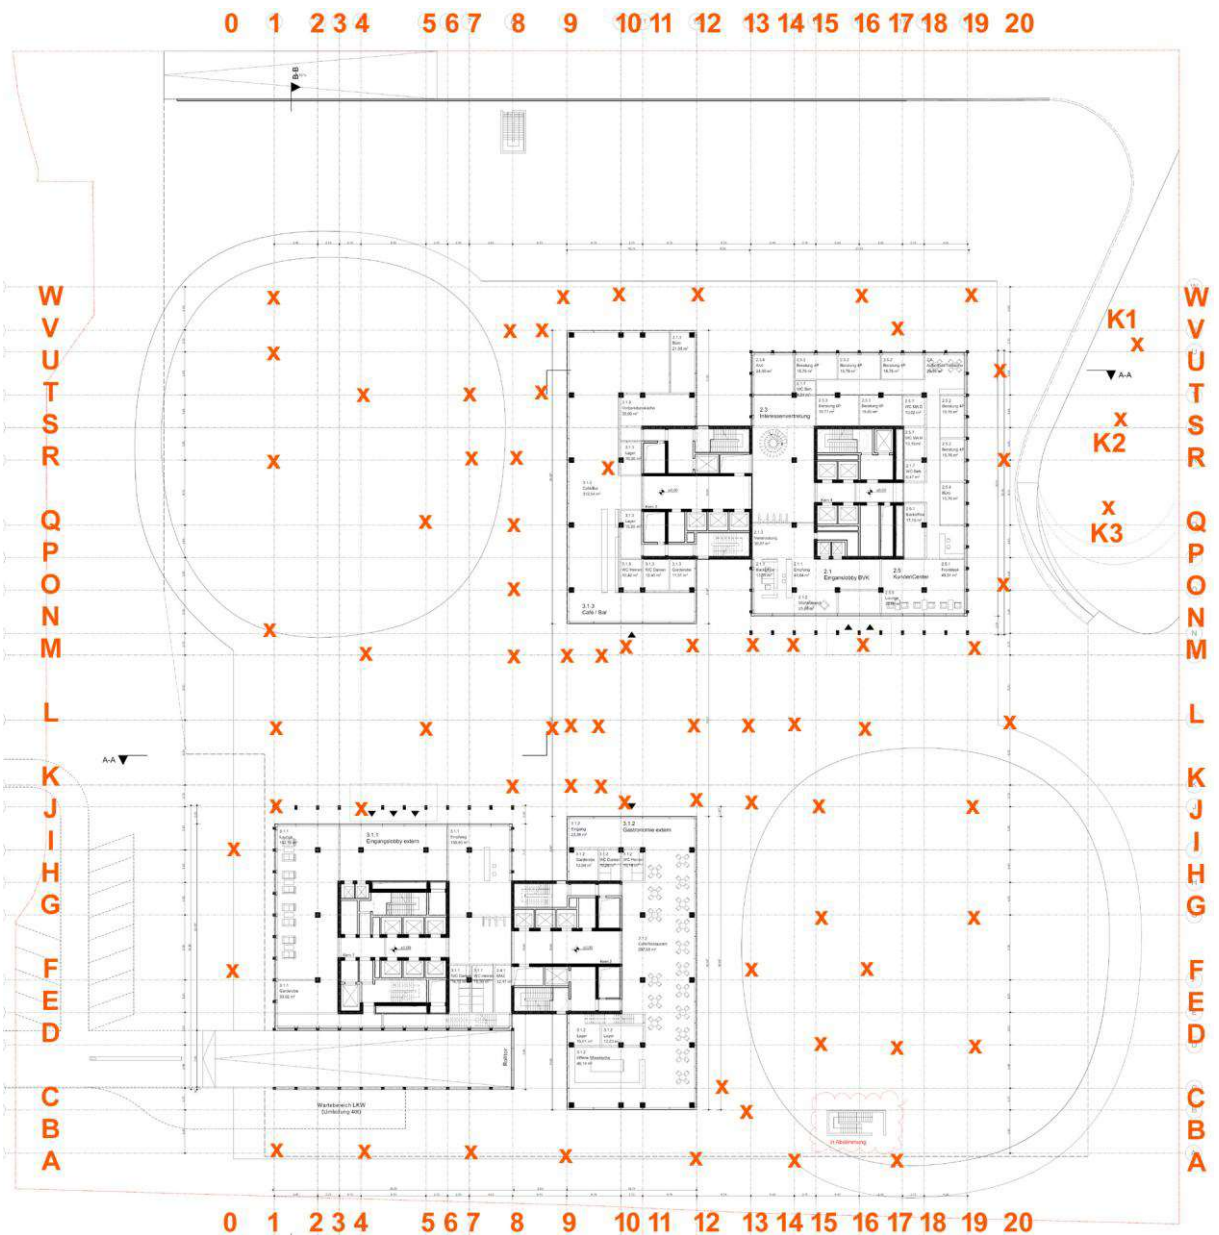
Grundriss Erdgeschoss mit Gitterkoordinaten zur Beschreibung der Messpositionen
